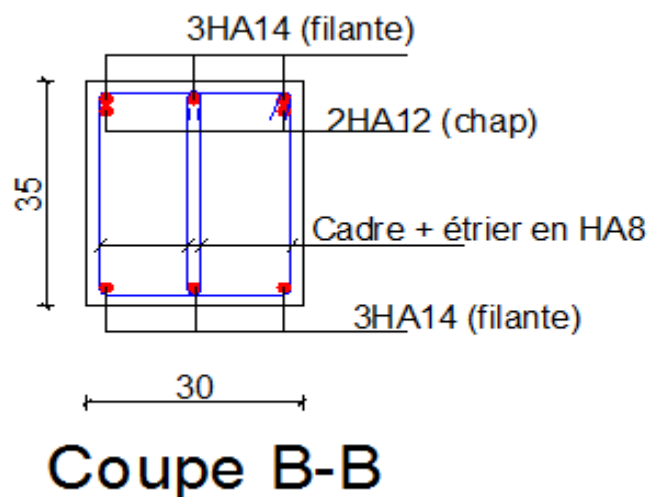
6: Ferrailage aux appuis d'une poutre secondaire.
